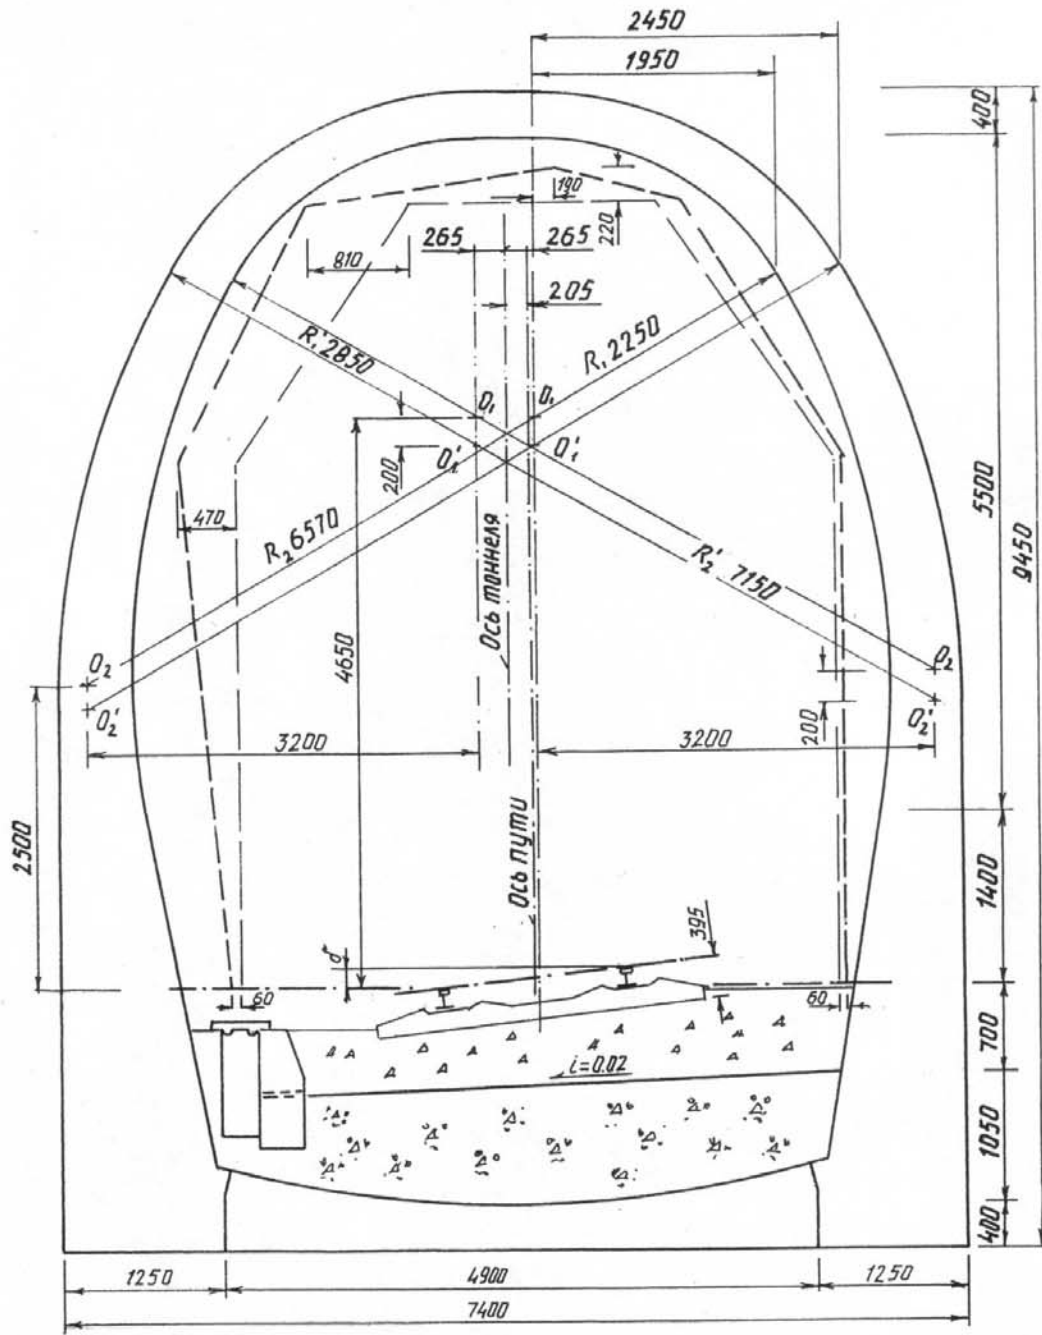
Монолитная бетонная обделка железнодорожного однопутного тоннеля на кривом участке пути радиусом от 250 до 1500 м в грунтах с $f = 4$
